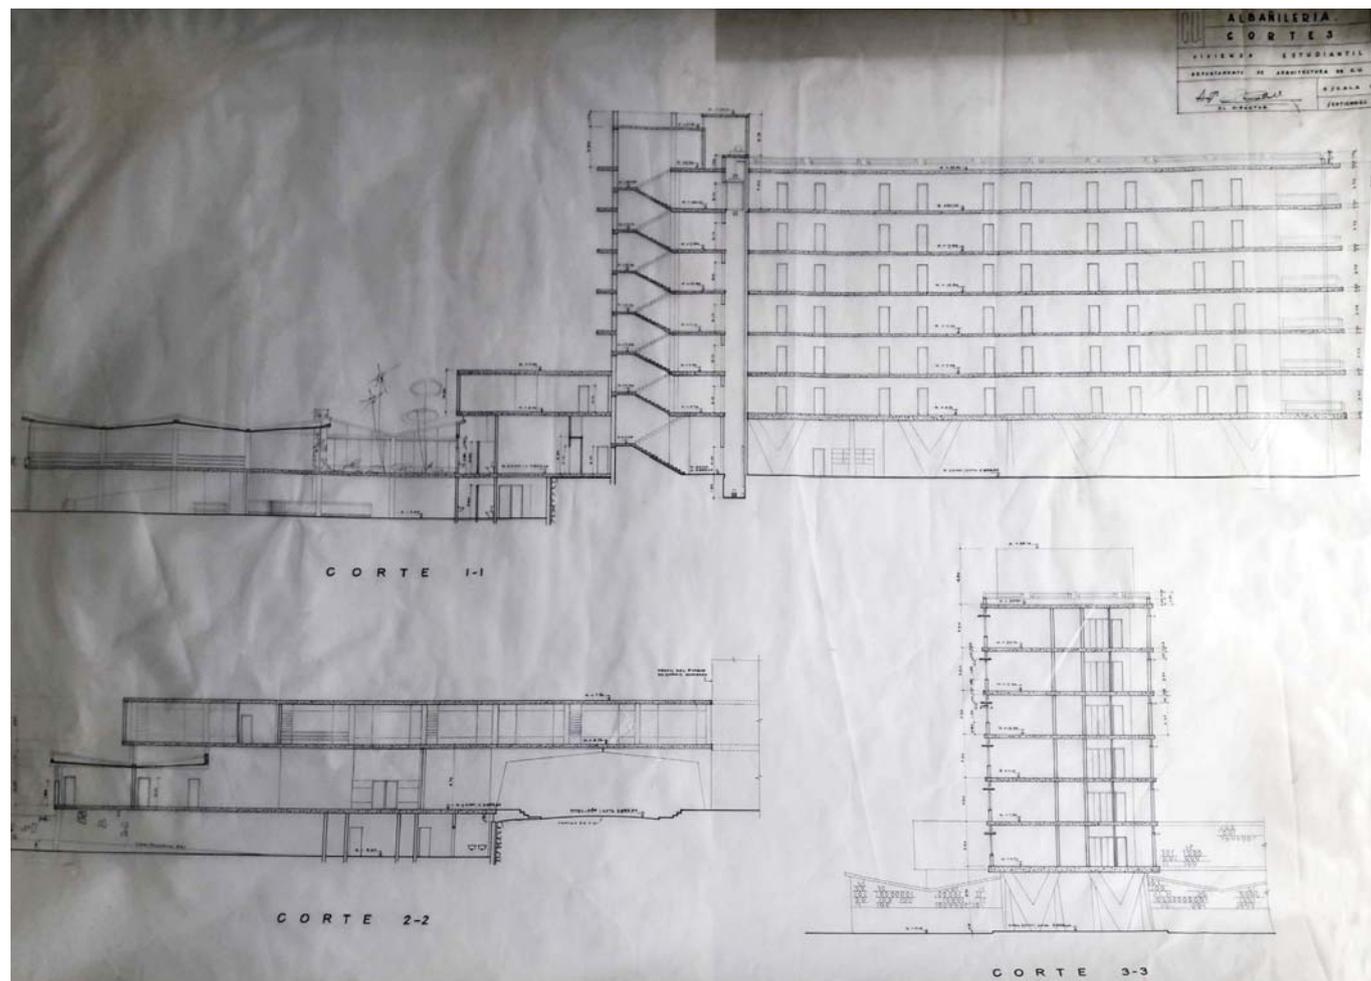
Fotografía de los planos estructurales del bloque construido columnas en "V"
